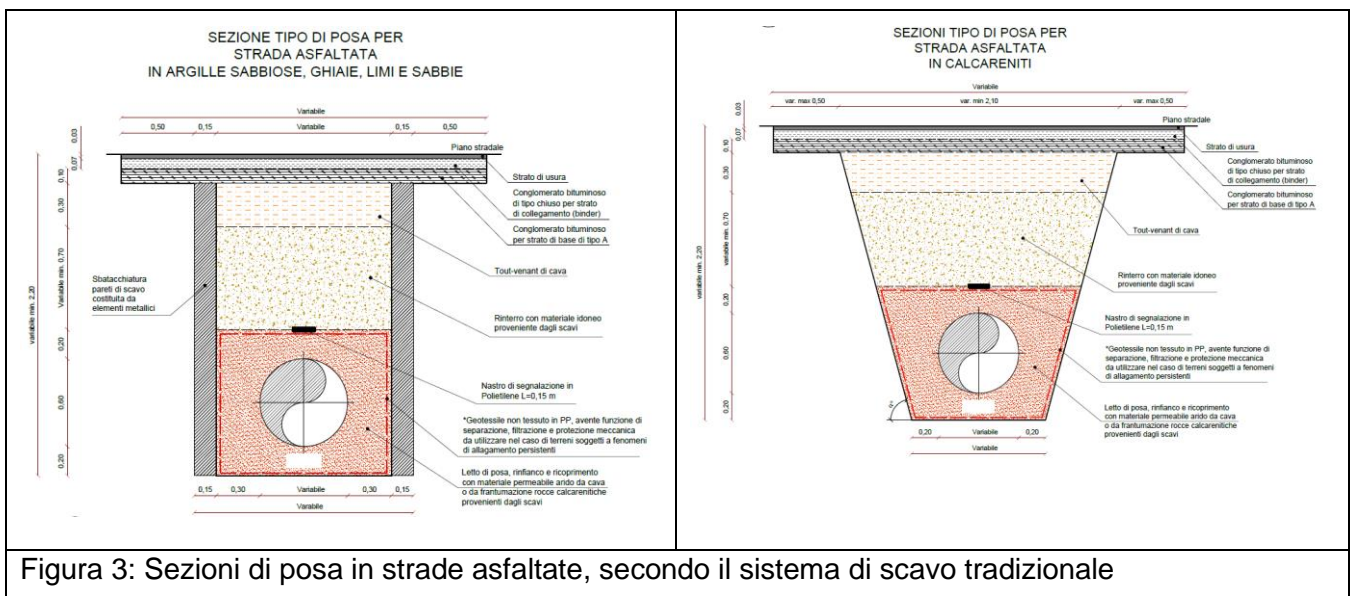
Sezioni di posa in strade asfaltate, secondo il sistema di scavo tradizionale
